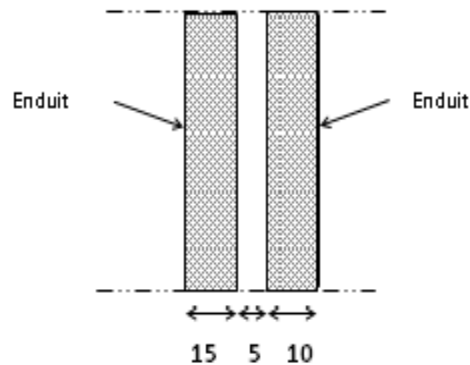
Coupe transversale du mur extérieur (en double cloison)
